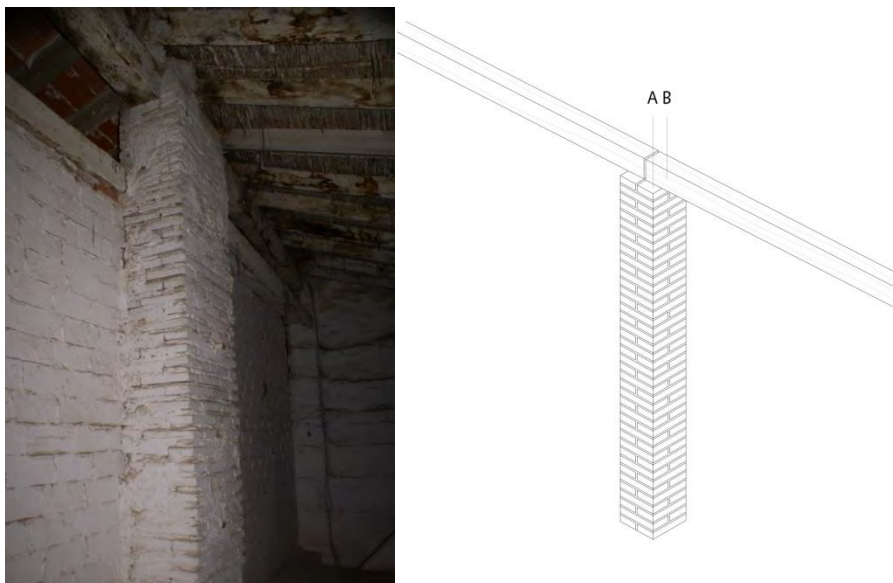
Vivienda en c/Mayor, 29. Pilar central de ladrillo en planta superior.
